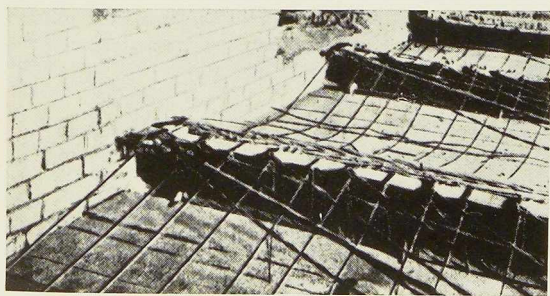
Ferrailage d'un hourdis continu en béton armé.
